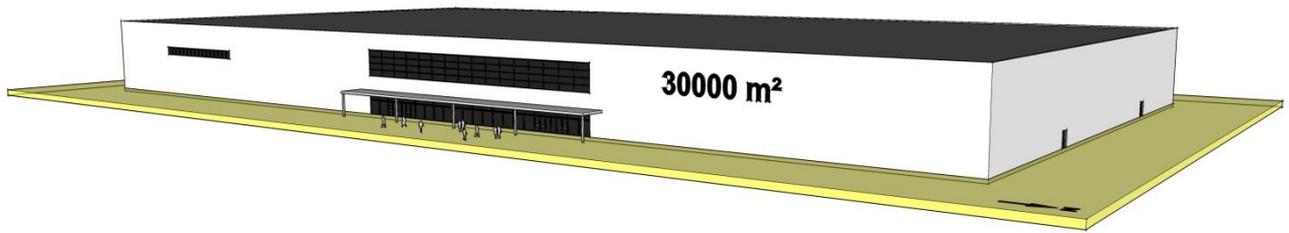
Verbrauchermärkte – Möbelhaus – Darstellung Gebäude – Ansicht Nord-Ost
